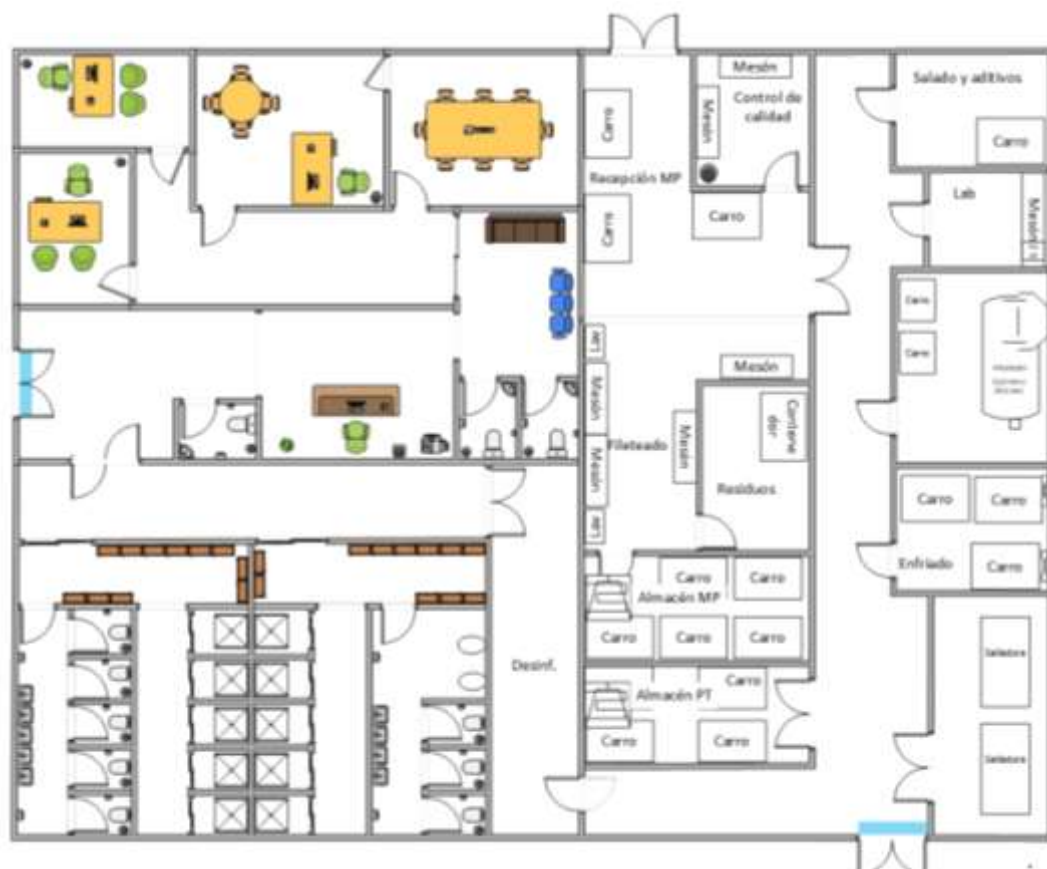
Distribución de los equipos requeridos a escala para la planta piloto con volumen de pesca artesanal.
